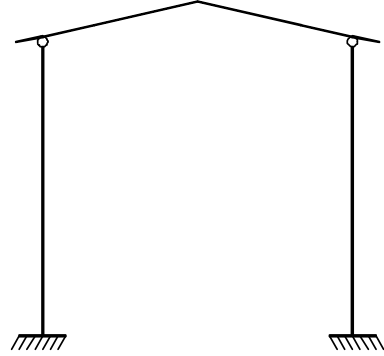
Articulações deslocadas para os pilares (apud EL DEBS, 1996).
